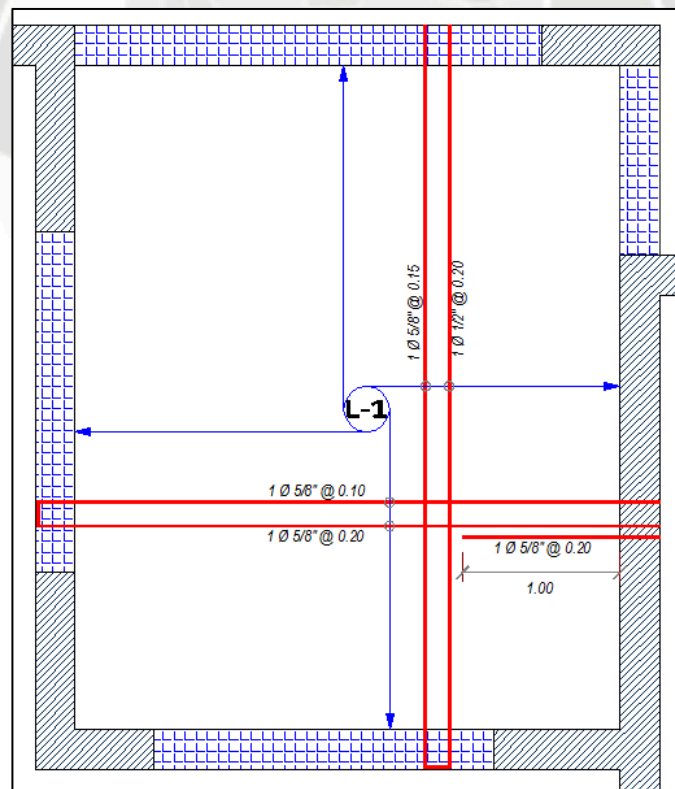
Diseño final de paño 01 de losa de cimentación.
